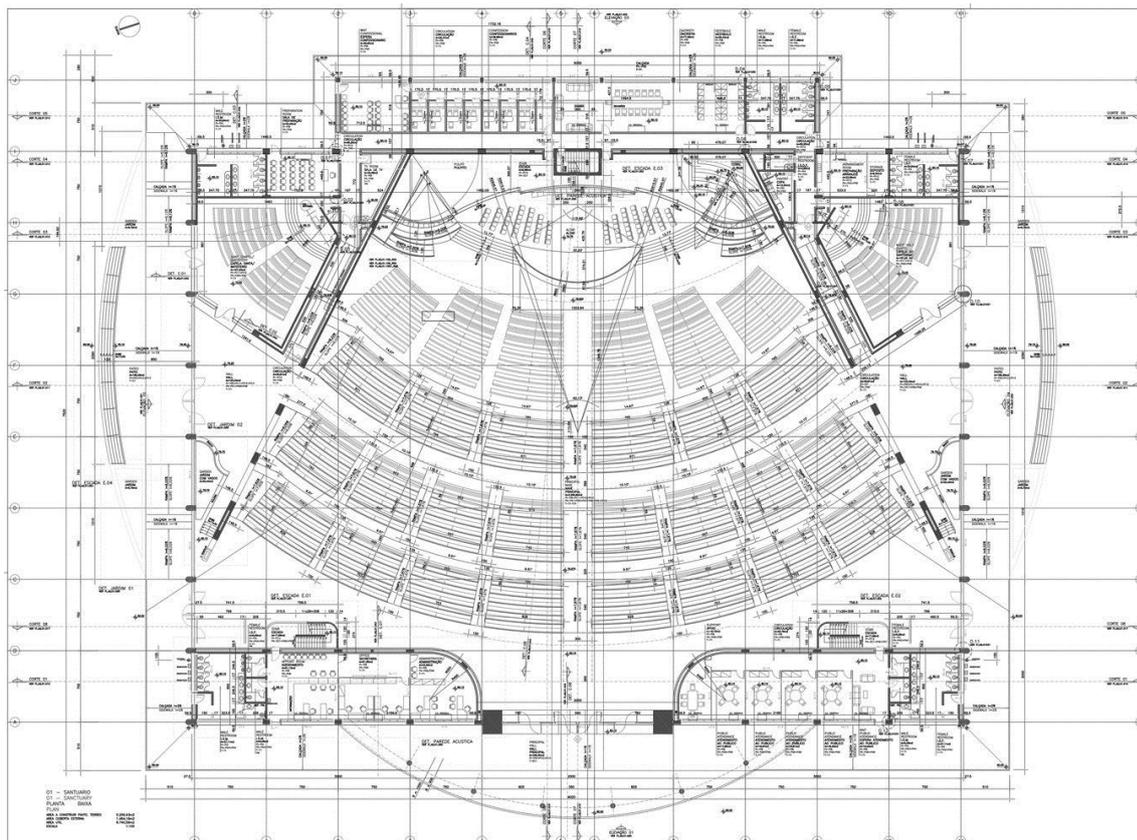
Planta baixa do templo do Santuário Santa Paulina. Fonte: HS Arquitetos
